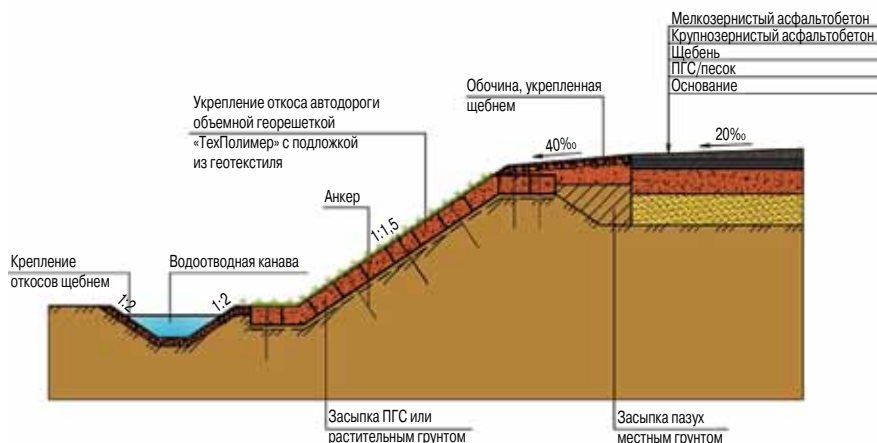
Пример геоимплантантной конструкции (ГИК). Укрепление откоса дороги геоимплантантами (ГИ) – объемной георешеткой, геотекстилем и анкерами
